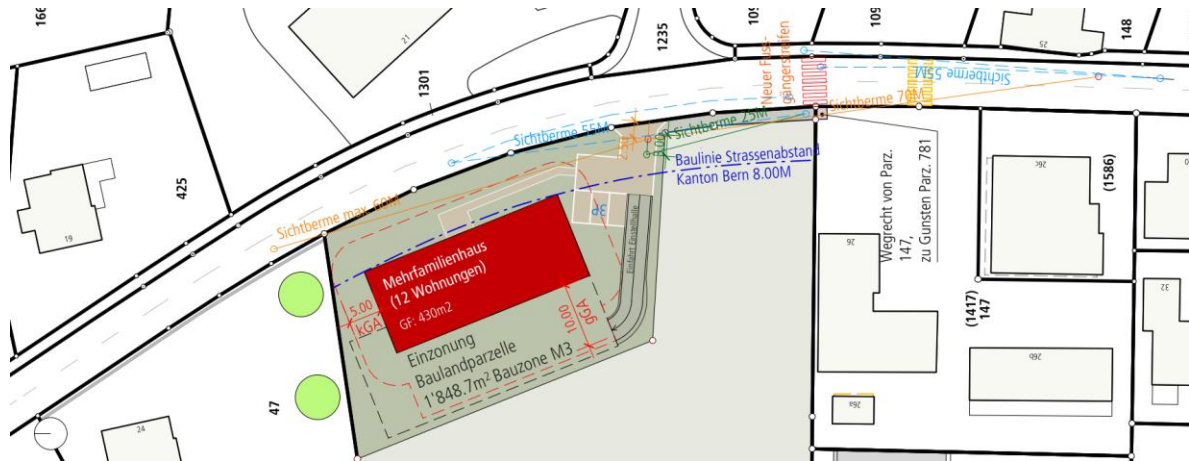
Grundstückerschliessung, Ausschnitt Plan «Teileinzung Parz. Nr. 781» HBR Architekten
